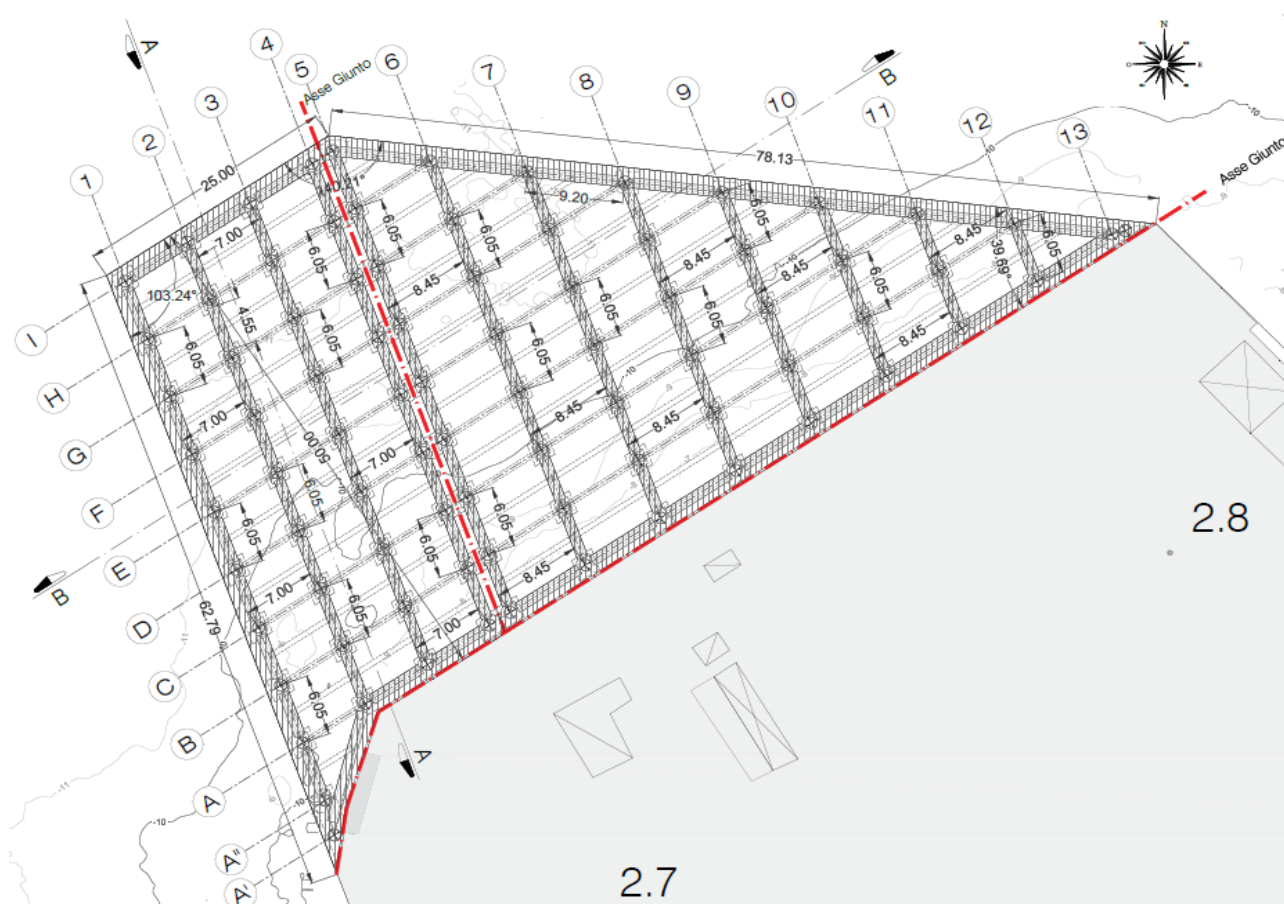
Pianta di progetto a quota +1.00 m con struttura portante dell'impalcato
